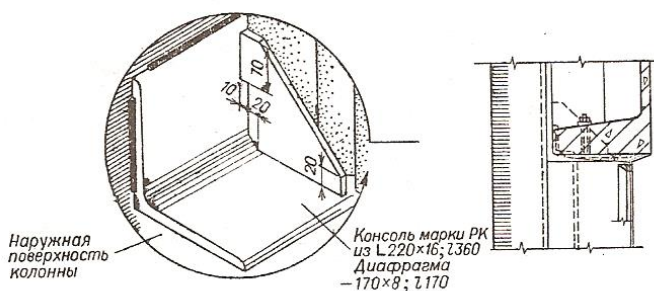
Навеска железобетонных панелей на колонну в местах устройства опорных консолей
